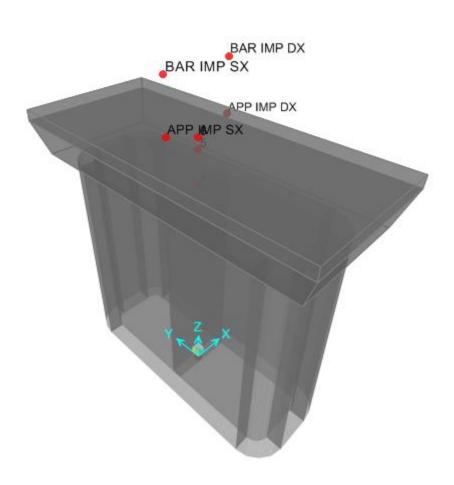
Vista estrusa del modello di calcolo delle pile
